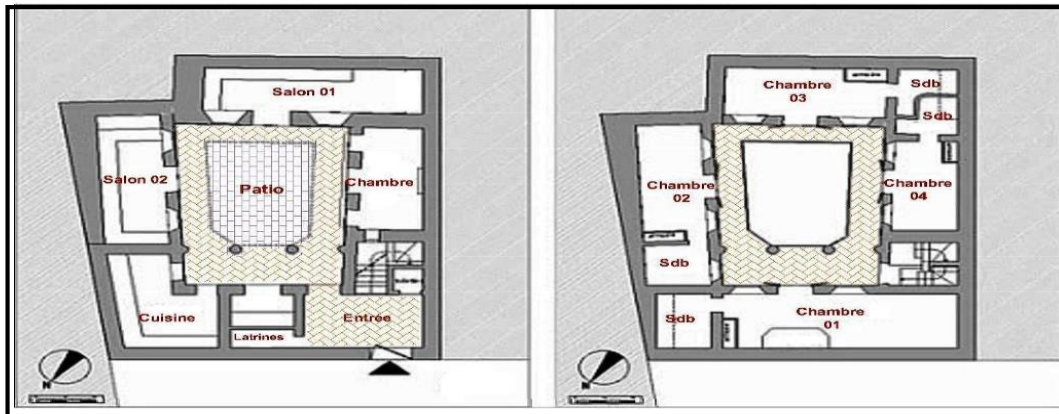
Plan d'une maison traditionnelle à Marrakech, -a- Plan rez de chaussé, -b- Plan étage.
